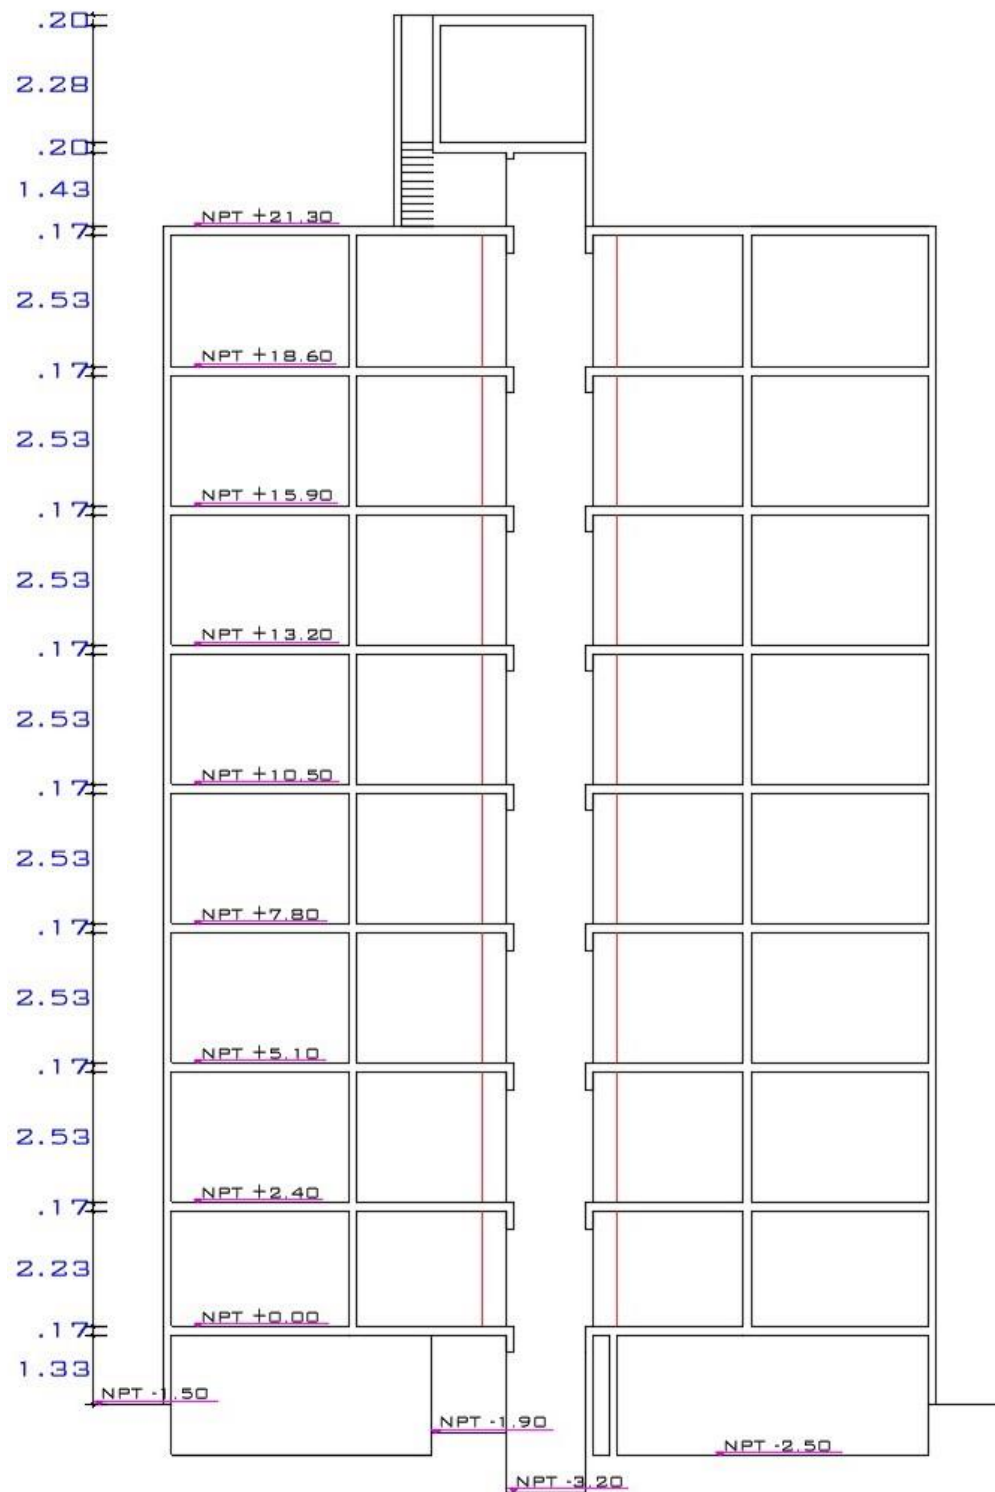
Elevación de la edificación. Fuente (Blanco P., 2014)
